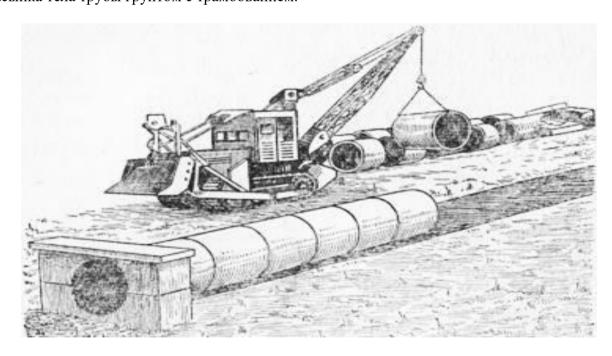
Схема укладки ж/б колец водопропускной трубы.
